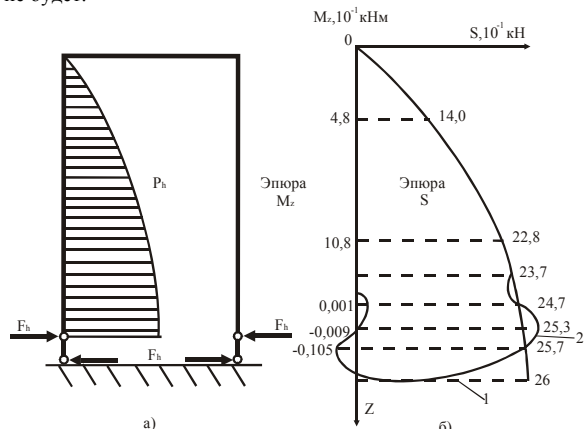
Расчет стен круглого силоса как длинной оболочки.
